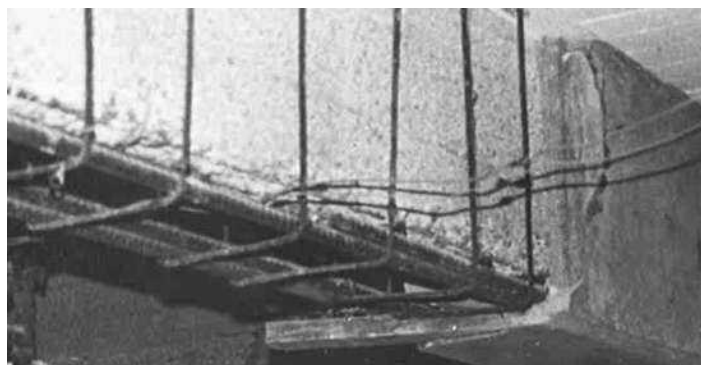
Armado de una trabe para encamisar con concreto reforzado
